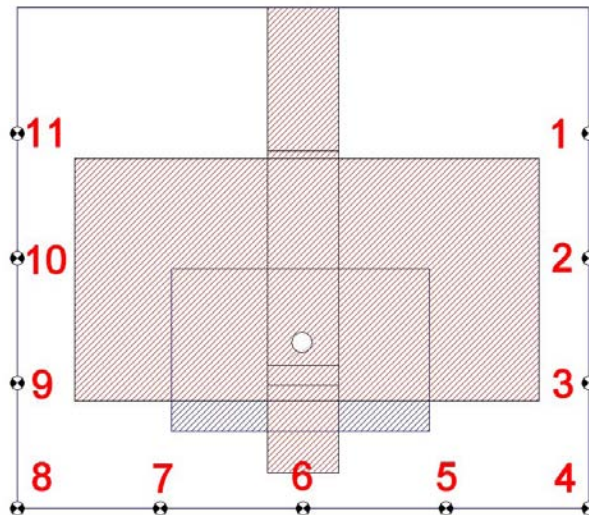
Messpunktachsen 1 bis 11 im Grundriss
